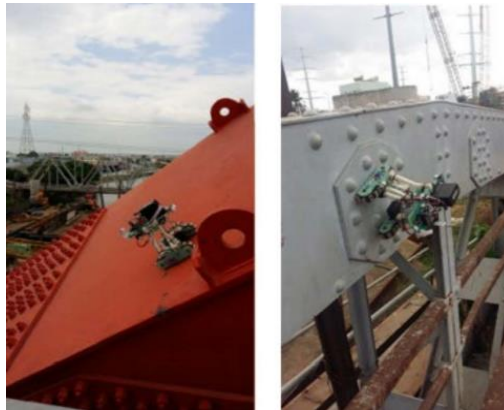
Primjena dronova u inspekciji čeličnih mostova [28]
